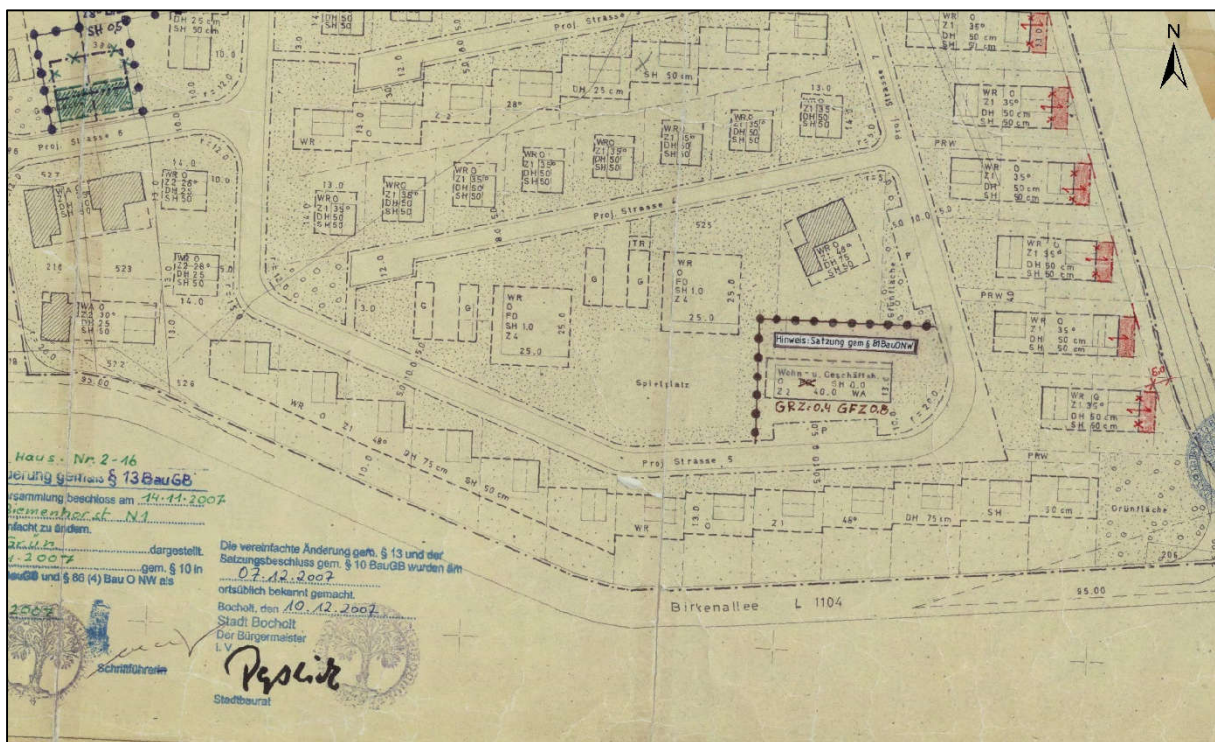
Auszug aus dem seit dem 20. Juli 1966 rechtsverbindlichen Bebauungsplan 2-N1
